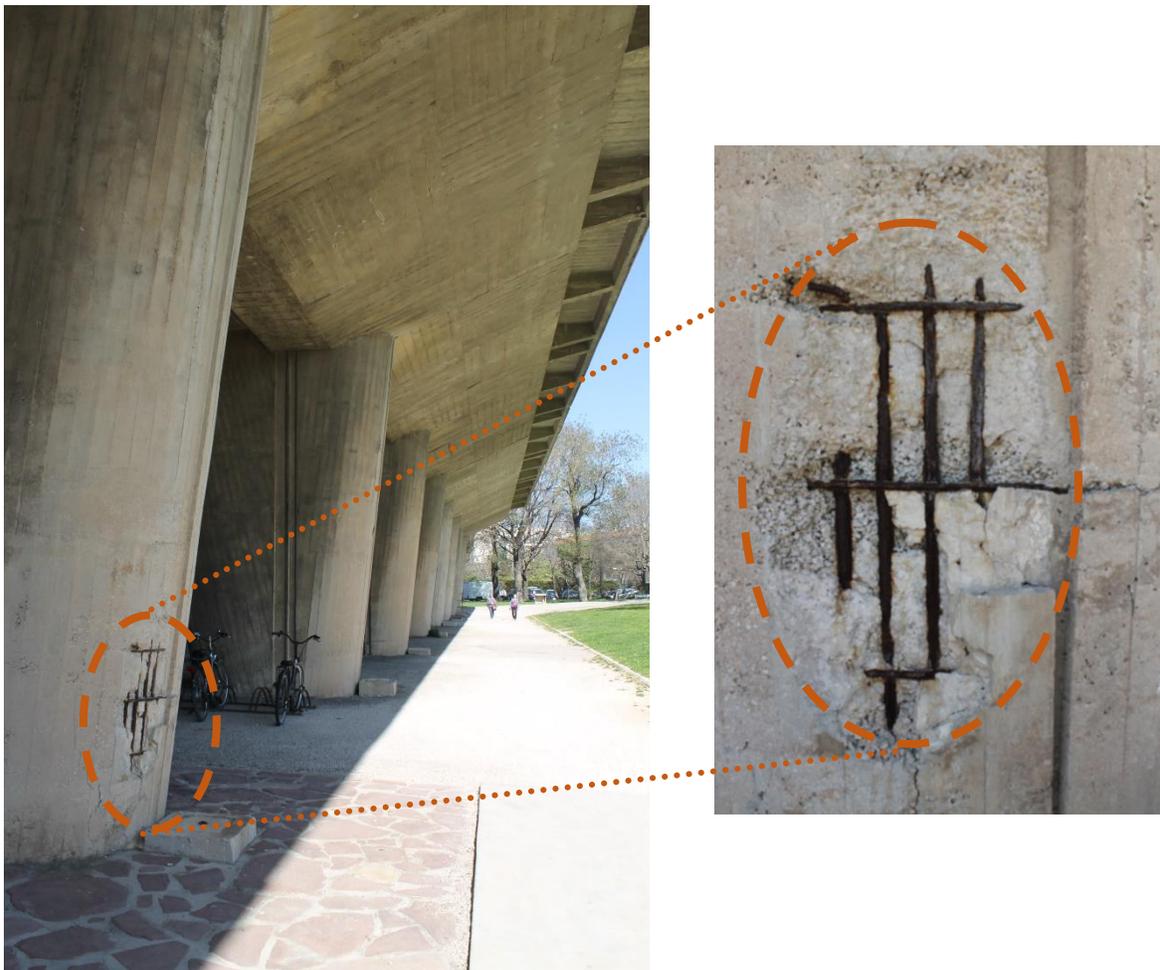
varillas de concreto armado expuestas en pilotis de la unidad de Marsella. Fotografía del autor, marzo de 2014
